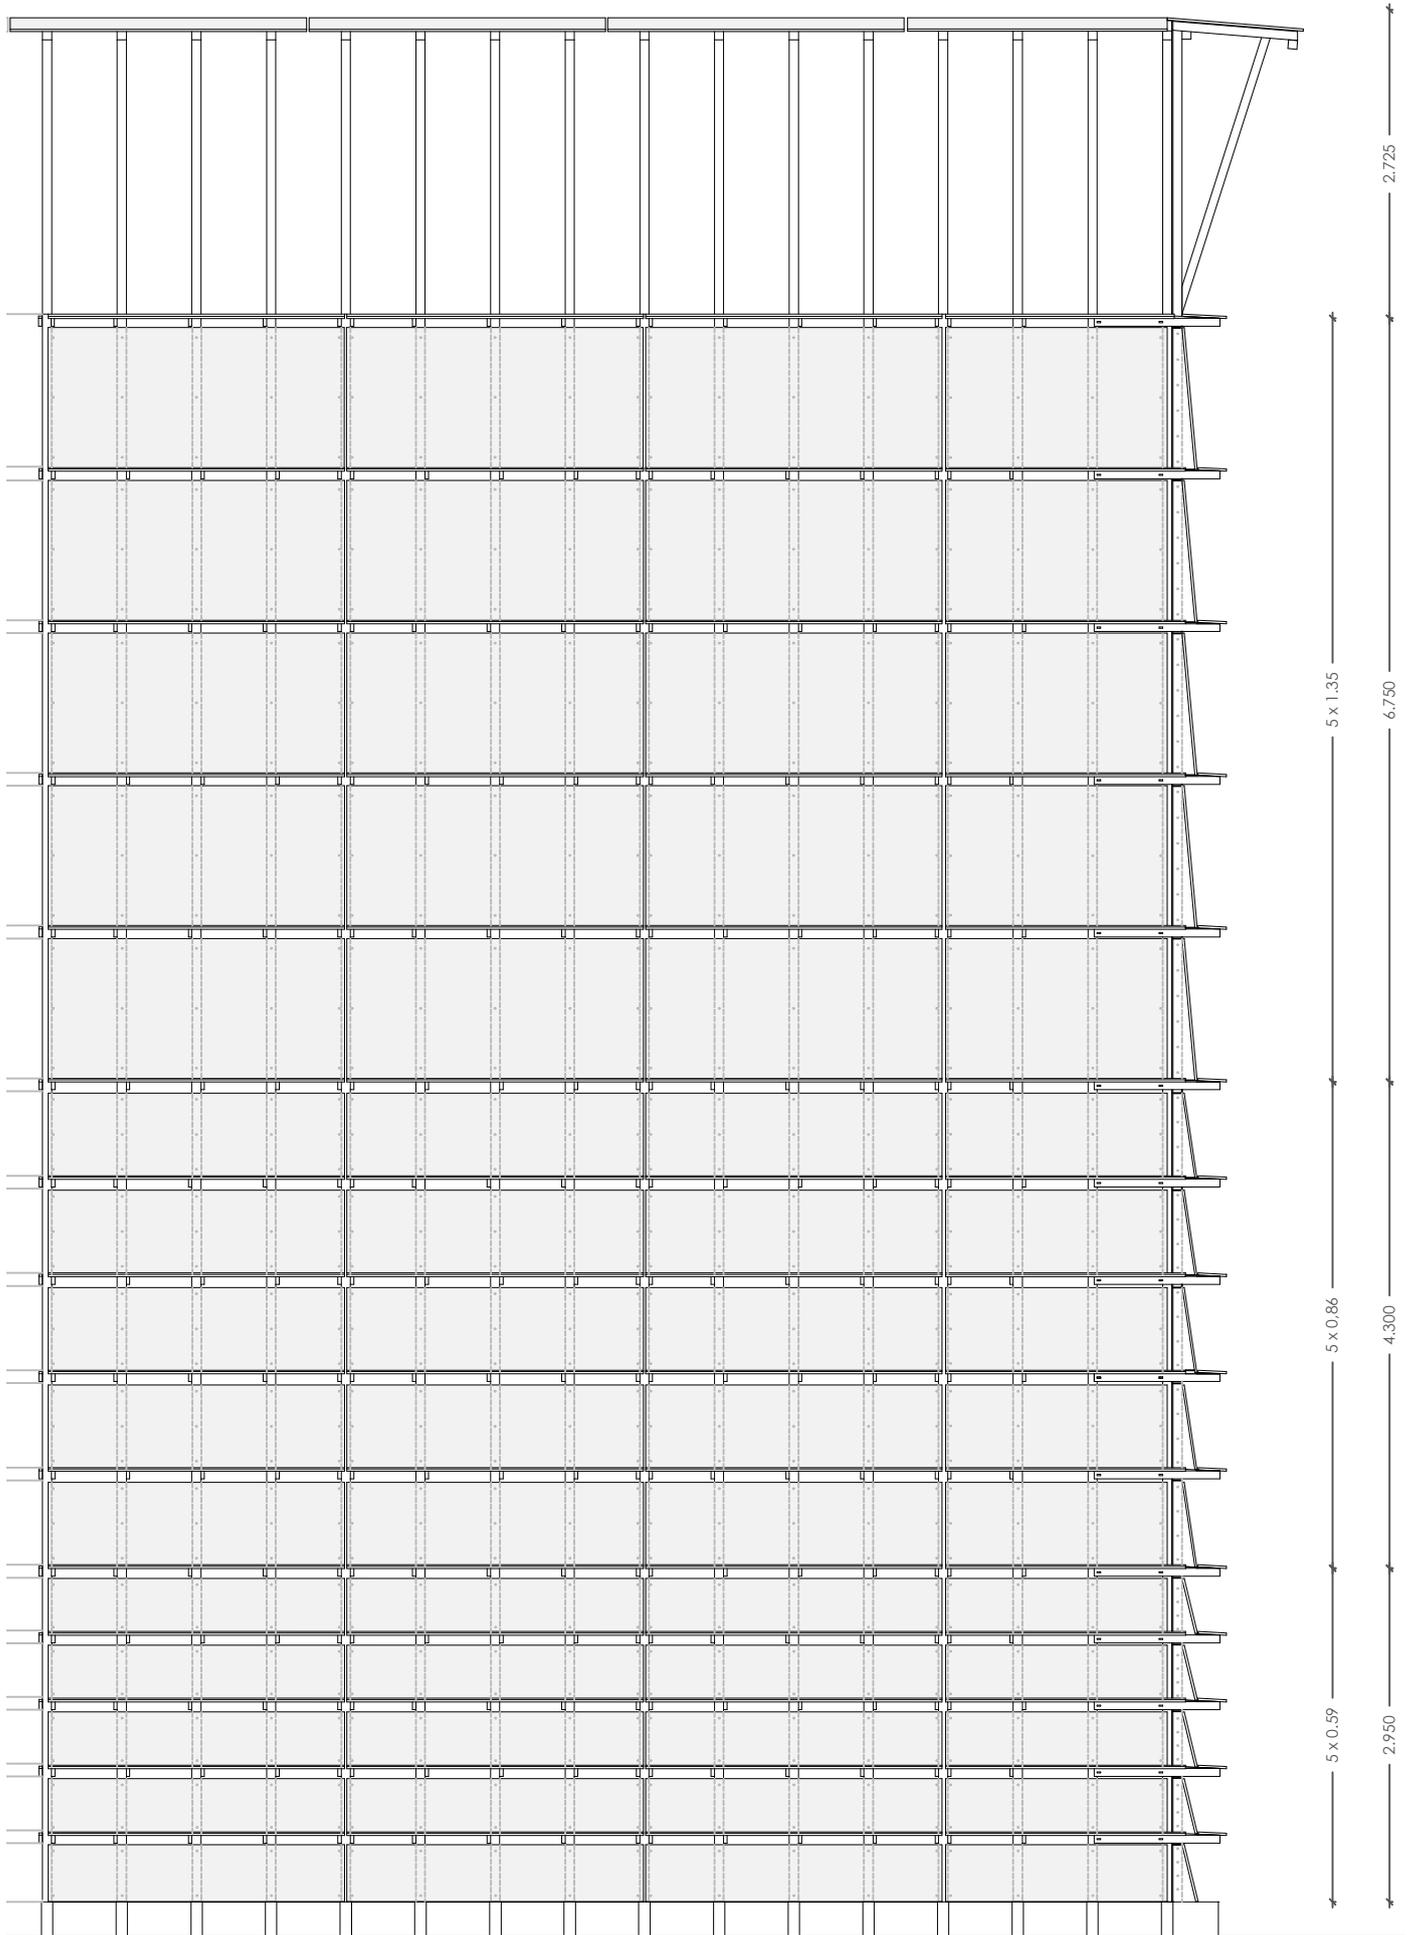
Alzado Almacén Rícola. Esc, 1/50
